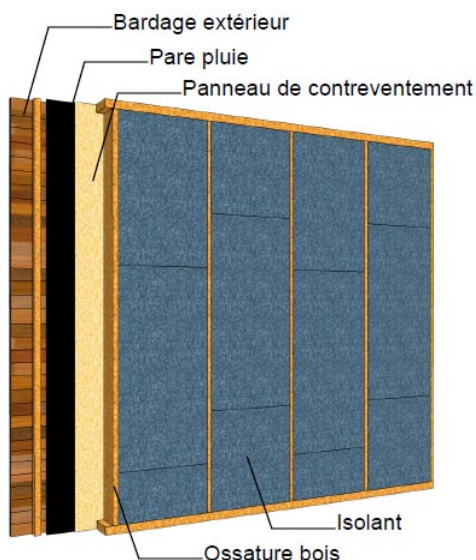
Mise en place de l'isolant en isolation intérieure de mur de construction à ossature bois.
